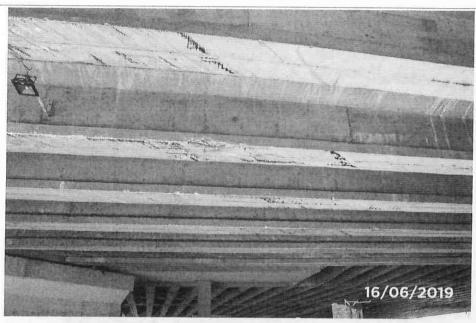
Detalhe das vigas com desplacamento de concreto, armaduras expostas e rompidas.
